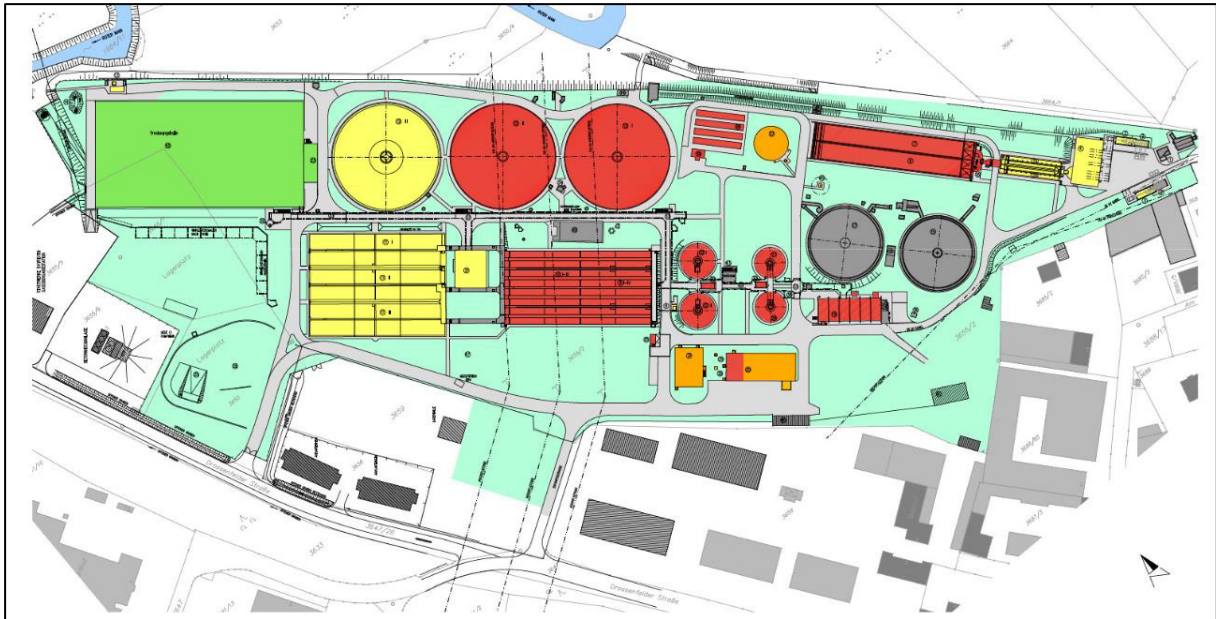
Lageplan der sanierungsbedürftigen Gebäude an der Kläranlage
